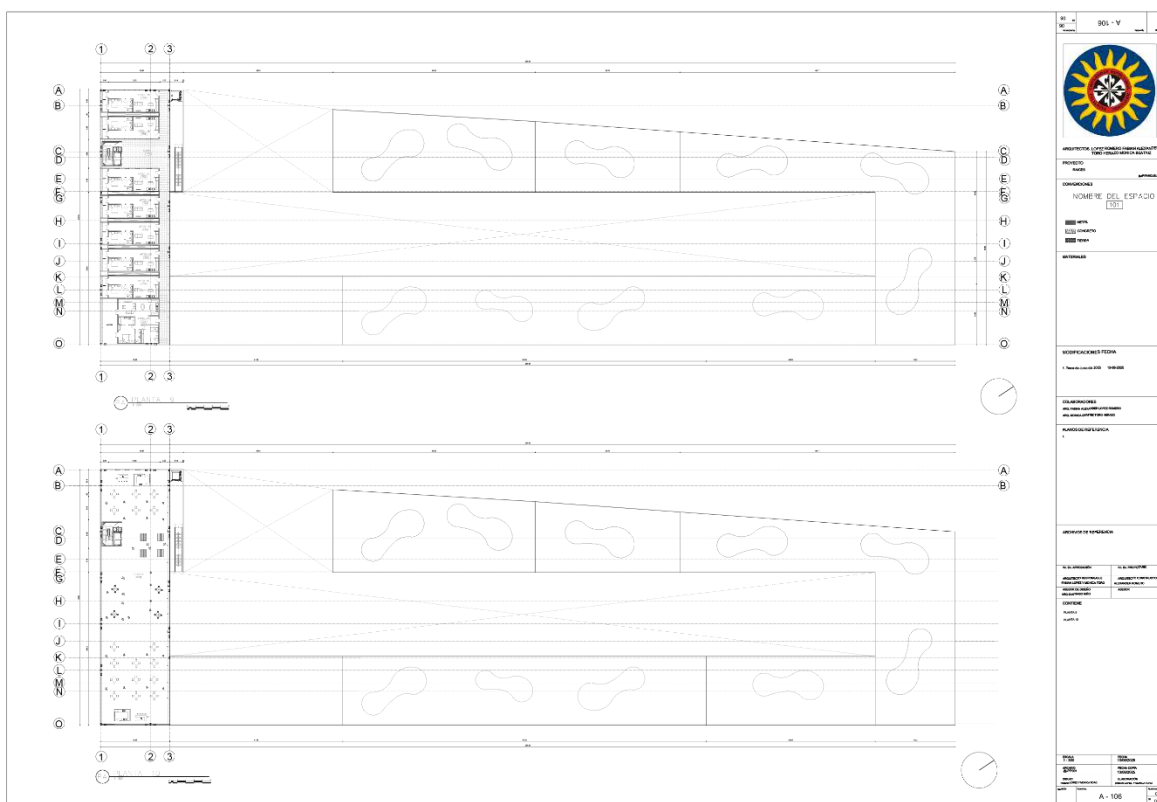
Planimetría Planta 9-10. Fuente: Elaboración propia.
